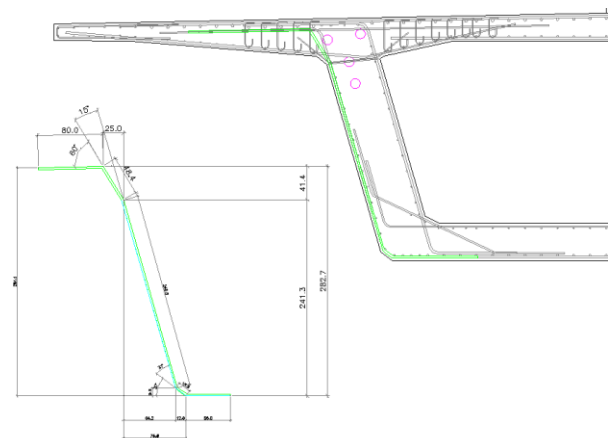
Viaducto sobre Río Guadalhorce y A-92. Pretensado. Sección de vano [5].
